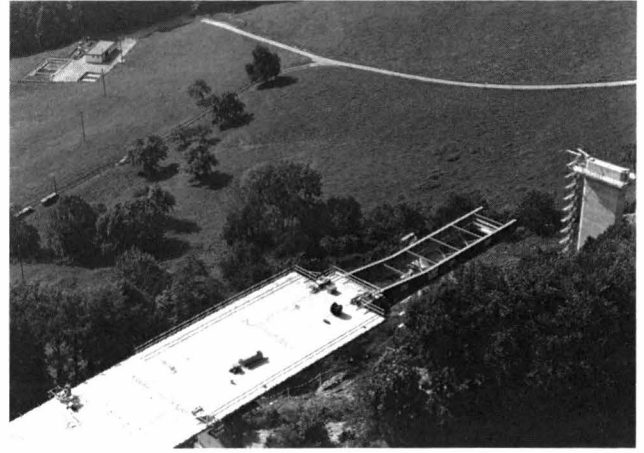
Brücke im Bauzustand mit dem Vorschubschnabel – Tablier en phase de poussage avec avant-bec – Bridge deck and launching nose in construction stage
